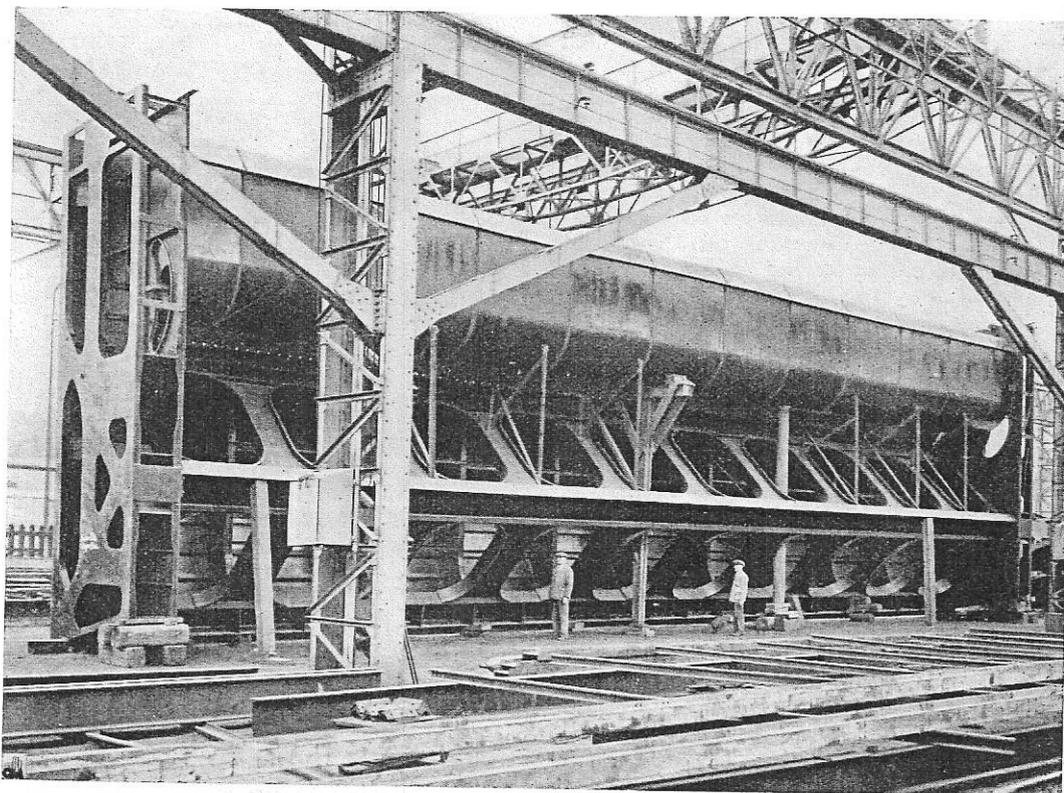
Vue aval de la bouchure principale, montée à blanc à l'atelier. On distingue nettement la charpente de la vanne principale constituée par deux poutres Vierendeel de hauteur constante et inclinées de 45° sur le plan horizontal.
